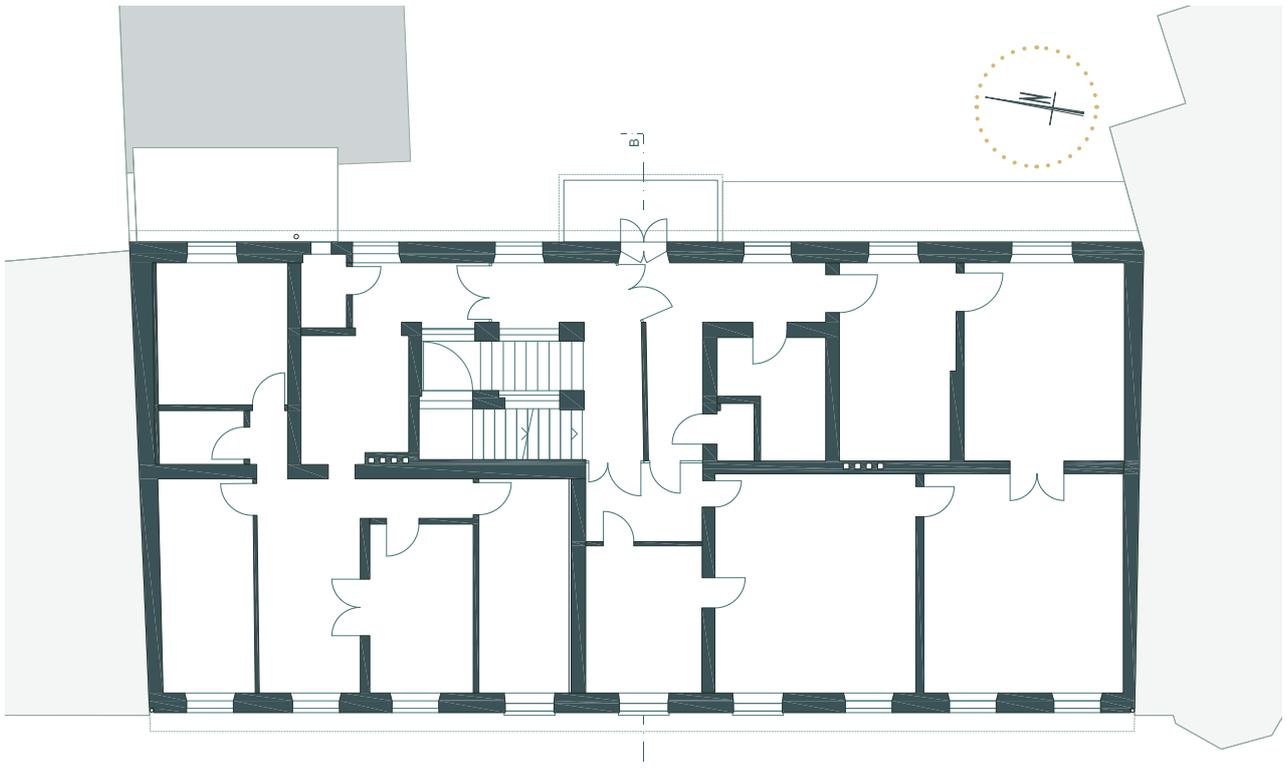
Grundriss Hauptgebäude, 2. Obergeschoß, $M = 1:200$
